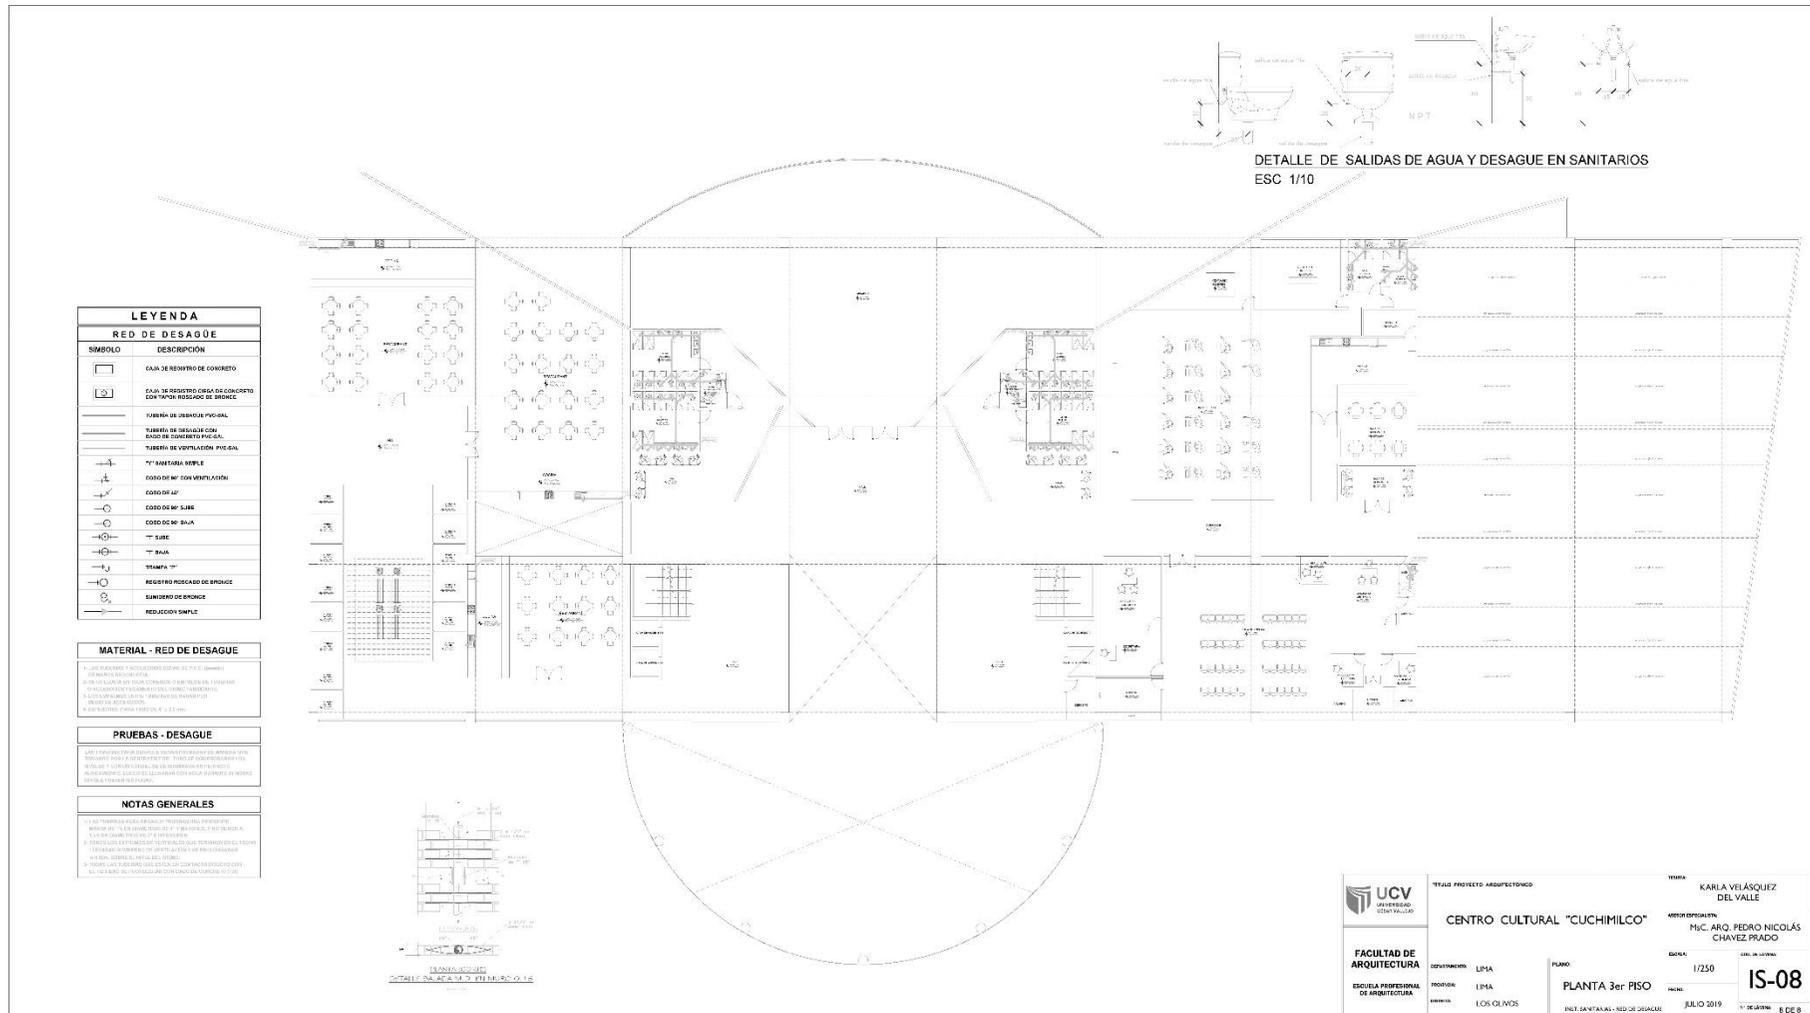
Plano de Desagüe Planta 3er Piso. Elaboración propia
